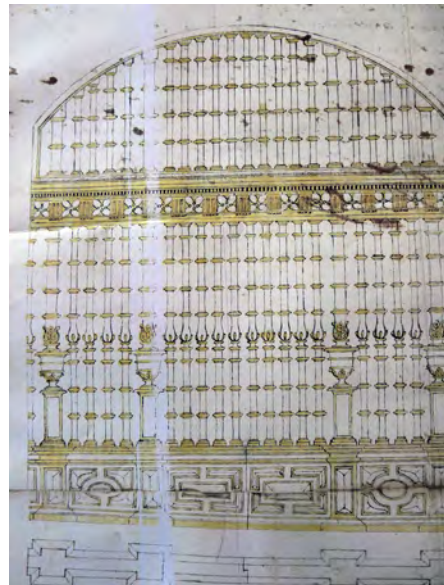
Planta y alzado de reja para la capilla de los Tordesillas Cuevas.
